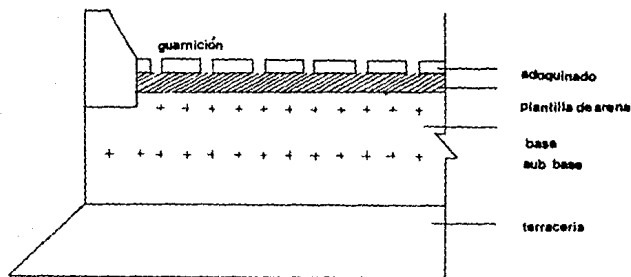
Sección típica de un pavimento de adoquín para tránsito
